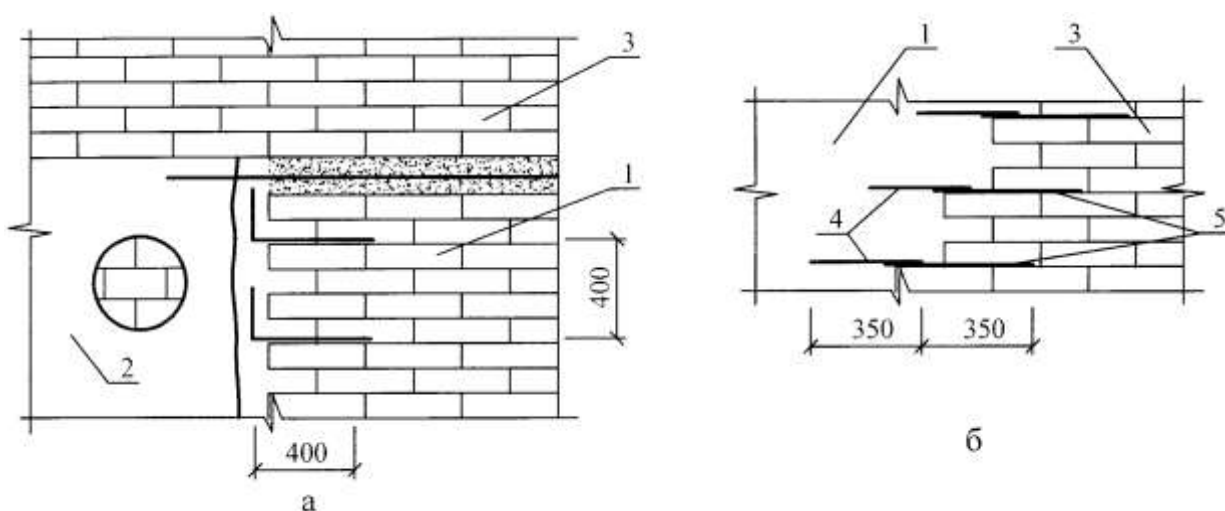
Соединение новой кладки на арматурных выпусках:
